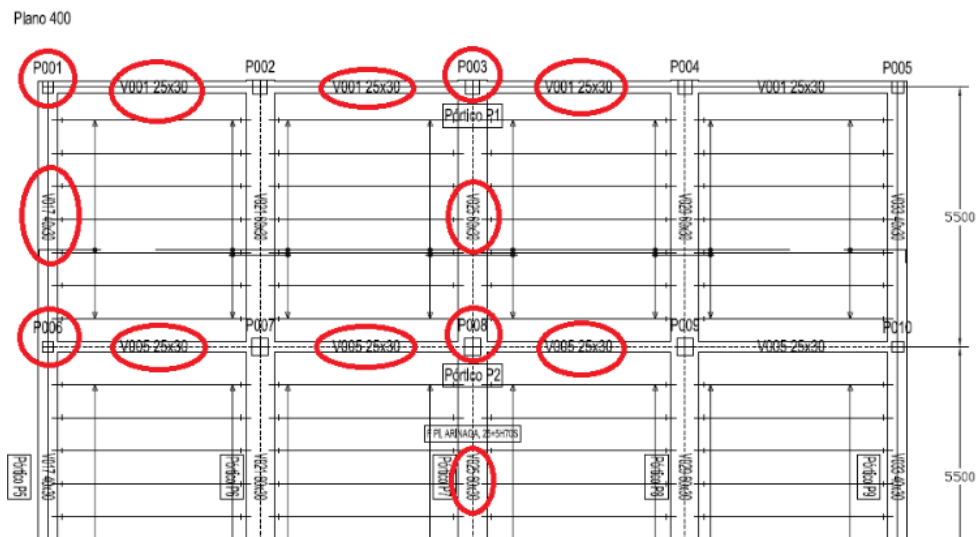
Vigas ortogonales al pórtico. Forjado incluido en el plano 5 del Anexo I.
